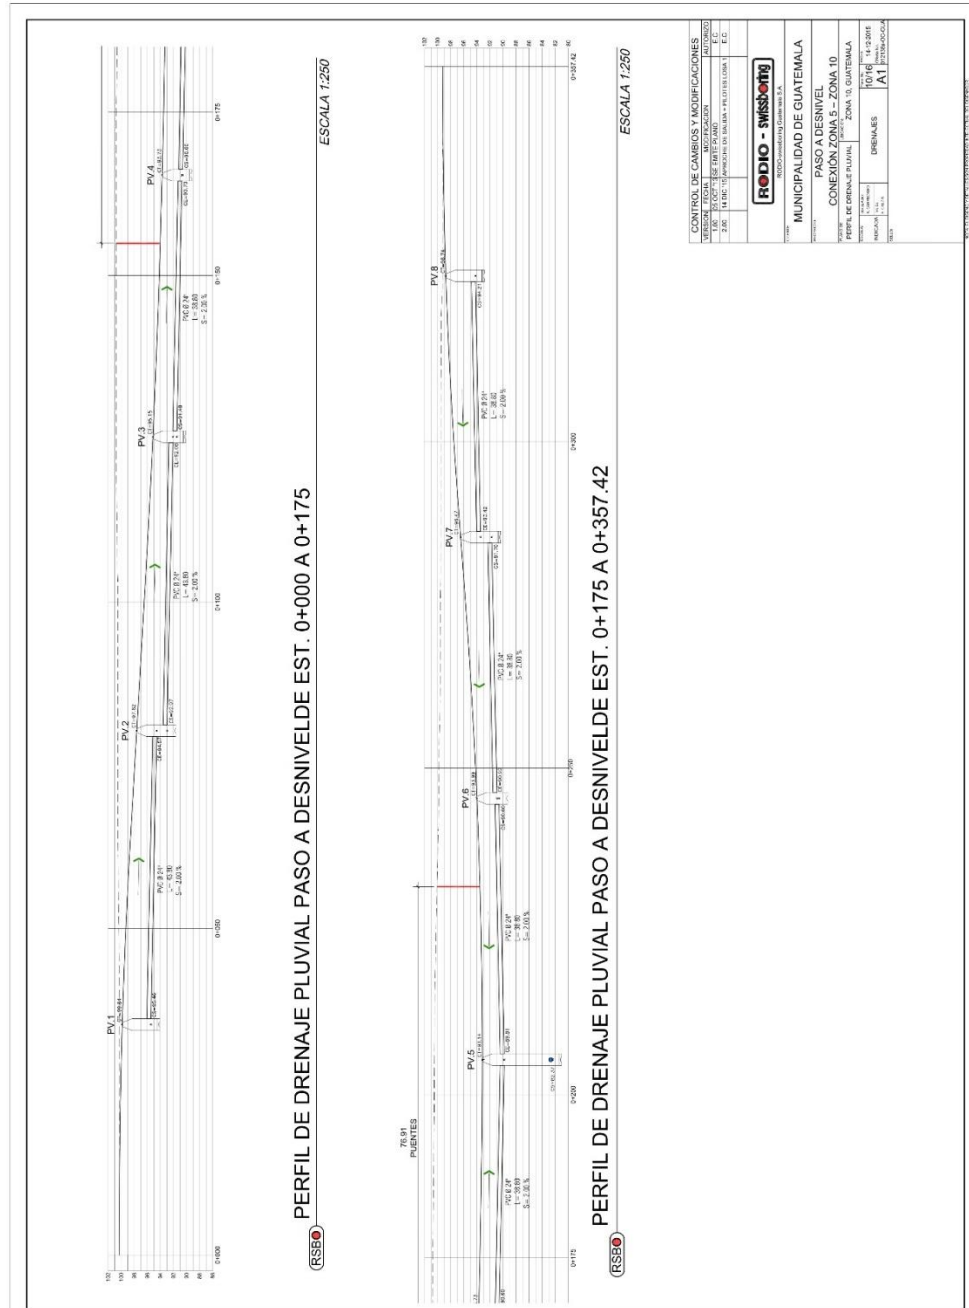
Paso a desnivel Guardia de Honor – Planta de drenaje pluvial
